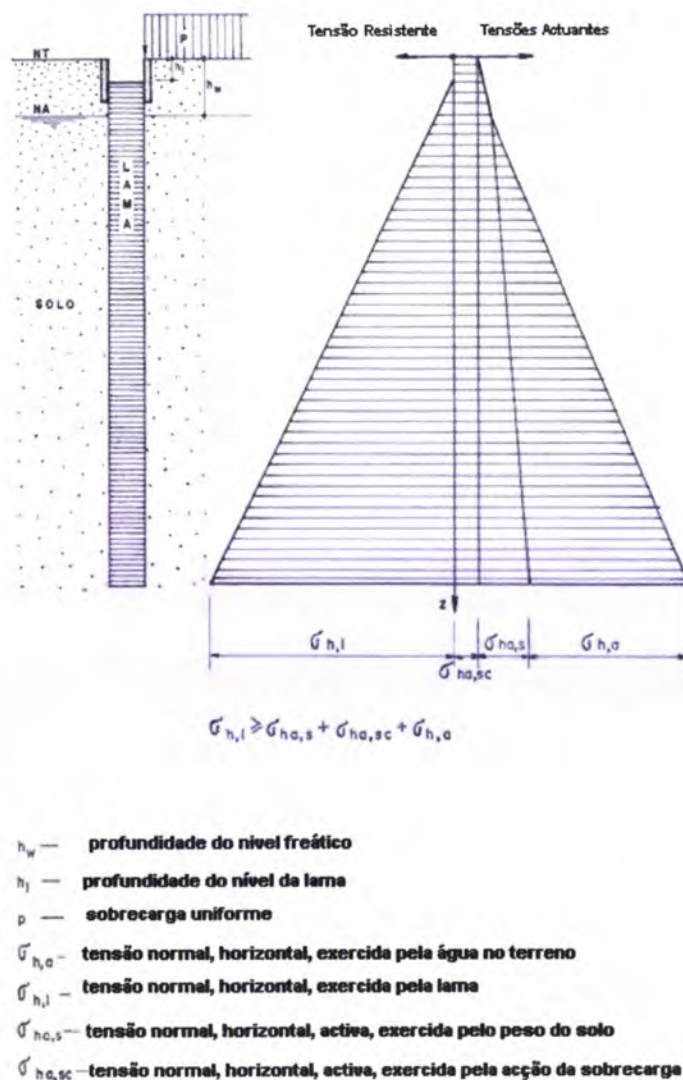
Acção estabilizante da lama numa escavação (adaptado de BOWLES, 1996).
